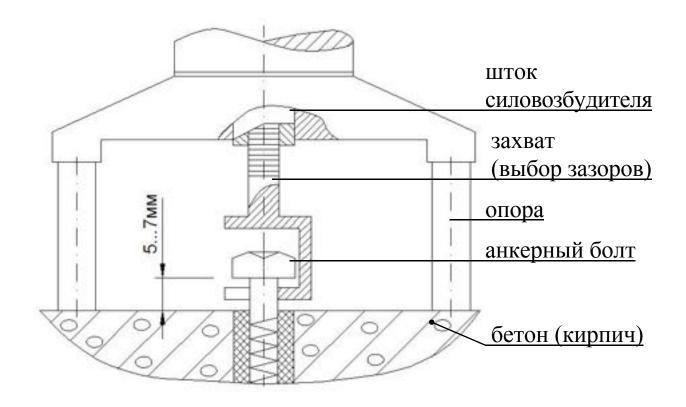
Схема подготовки прибора ПСО-МГ4А к измерениям
